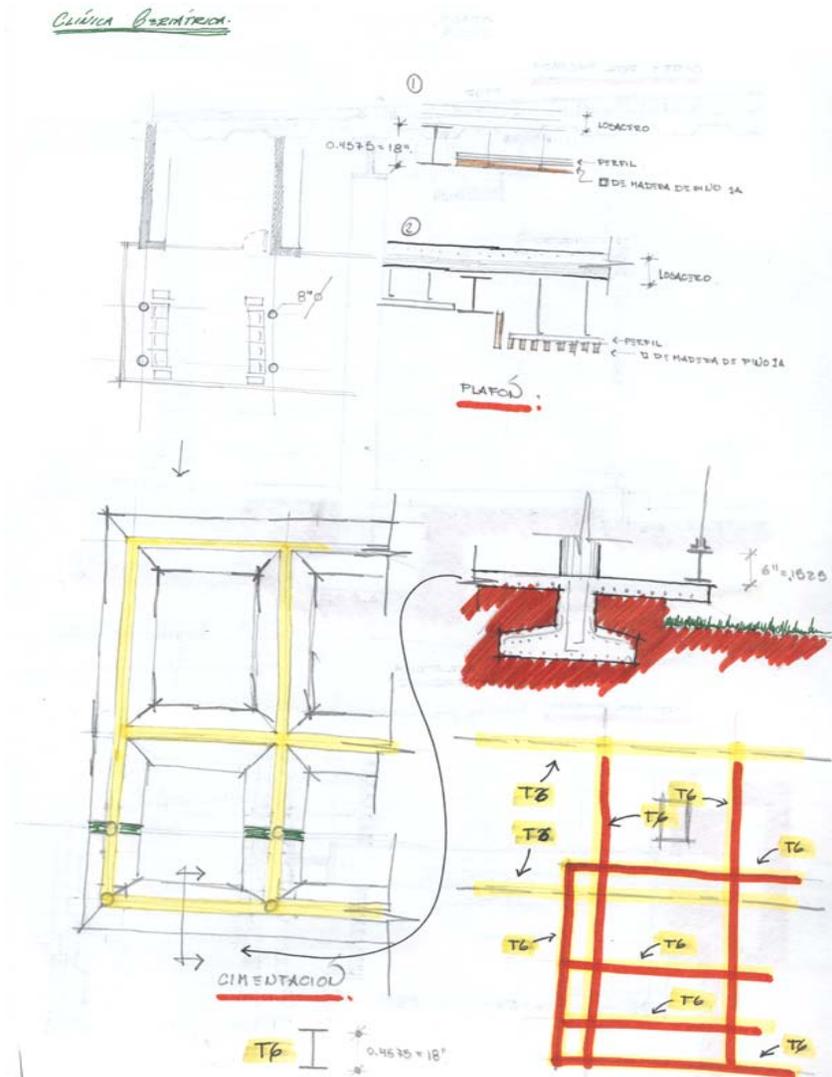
Estructura, cimentación y plafón. Clínica Geriátrica.
